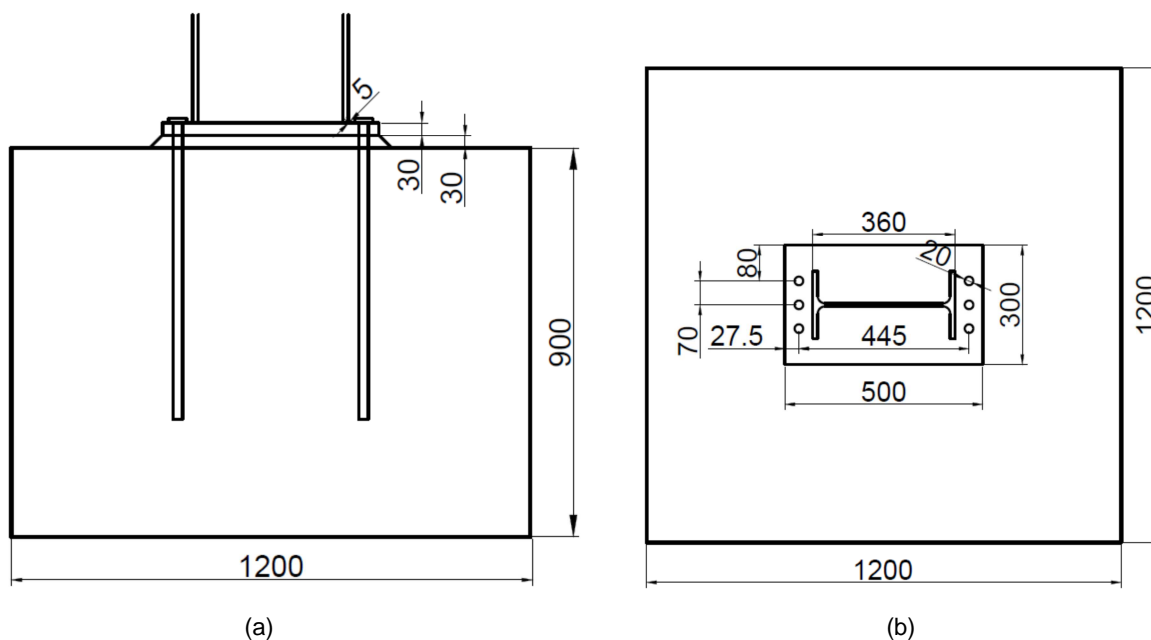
Definição geométrica da ligação do pilar P1 e P2 do pórtico 1
